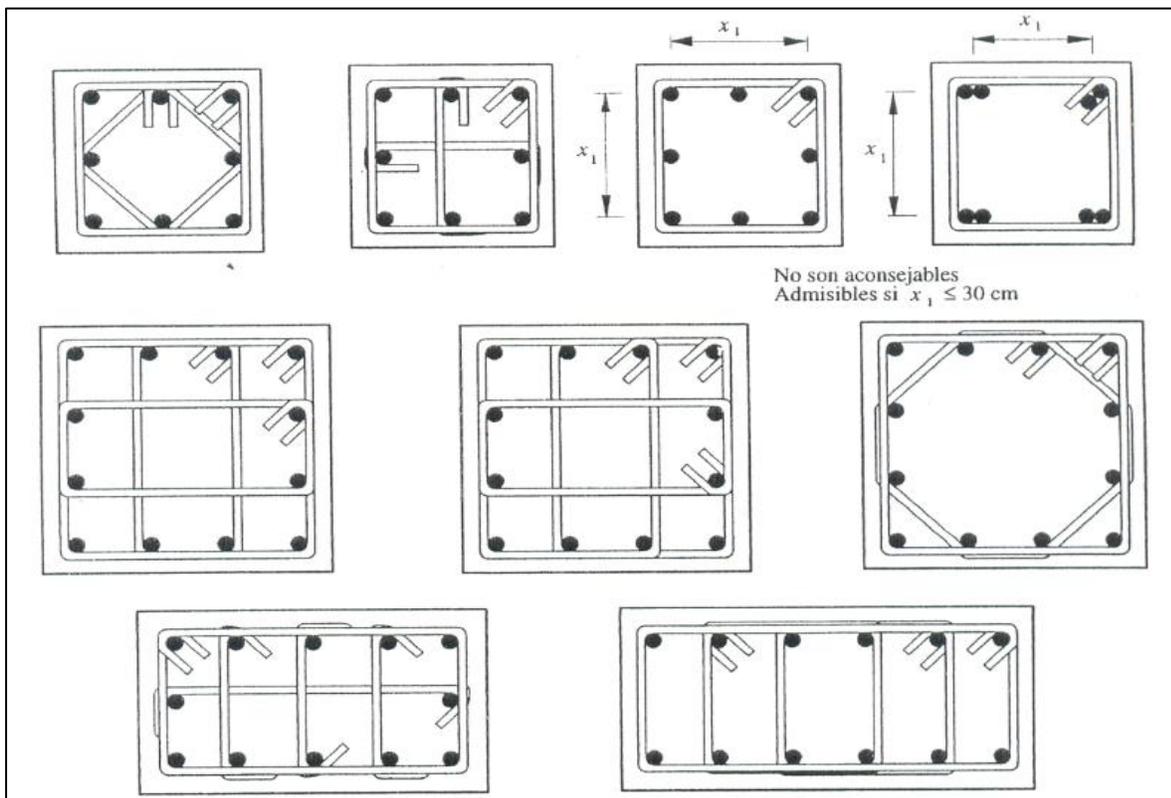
Arreglos admisibles de refuerzo en columnas de concreto.
